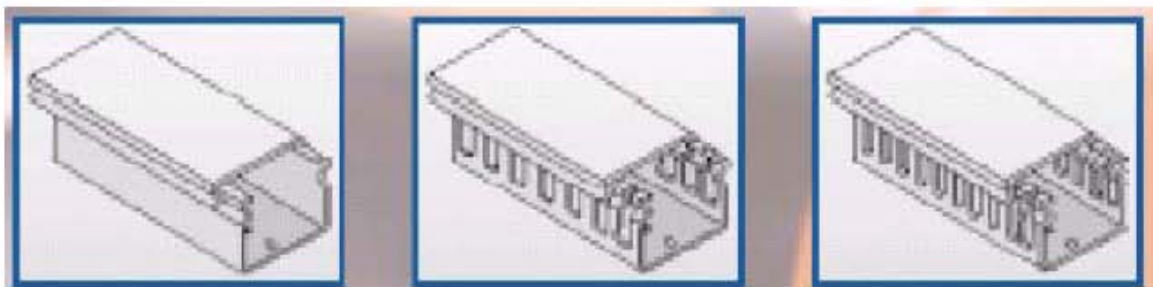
Ductos o canaletas aparentes metálicas o de PVC.
